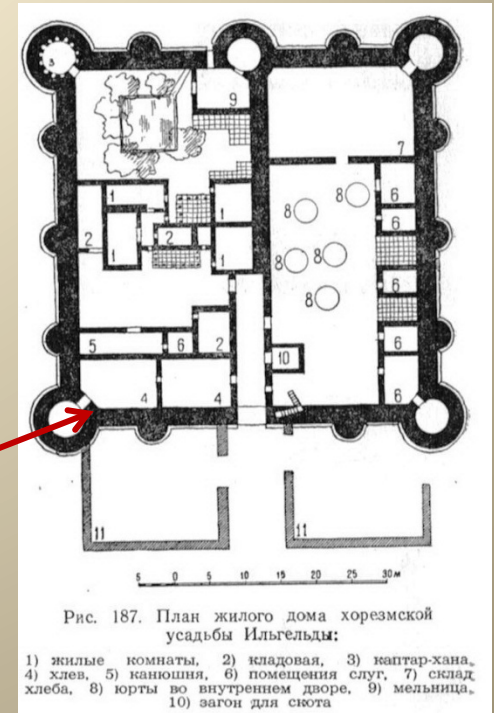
План жилого дома хорезмской усадьбы Ильгельды:
